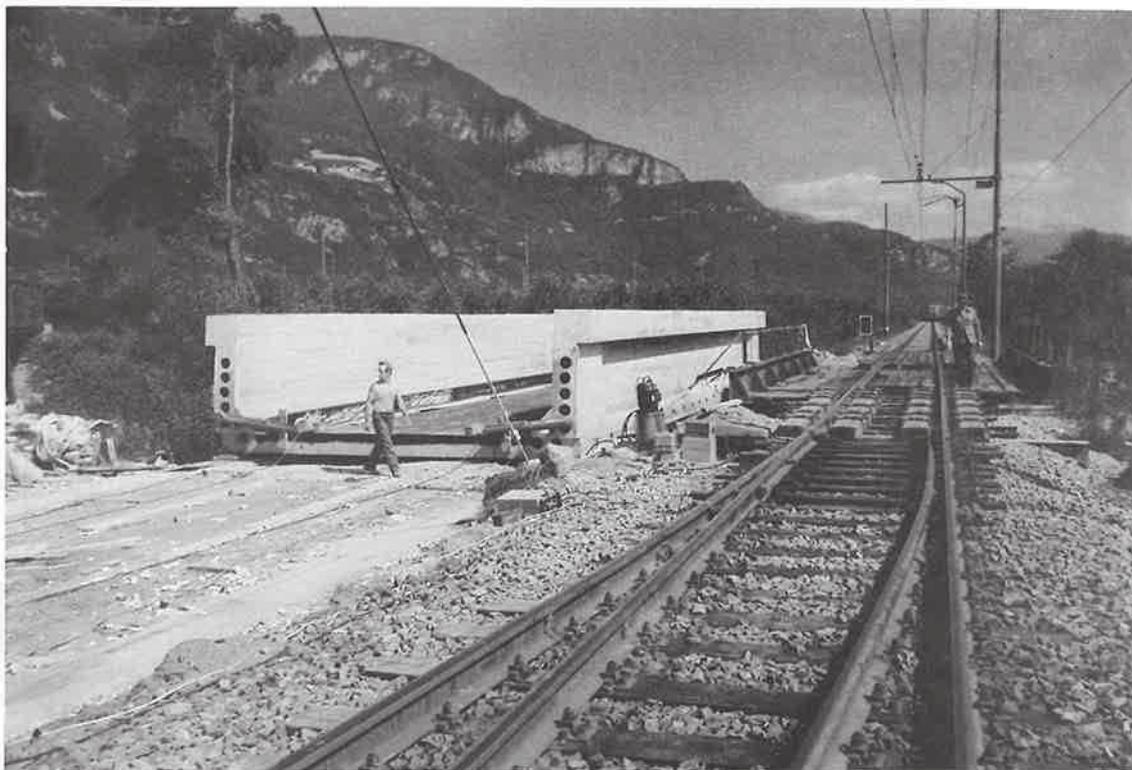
Il nuovo ponte affiancato al vecchio manufatto.
